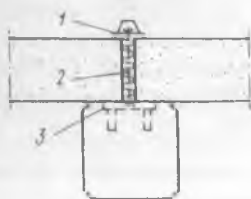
Соединение горизонтального стенового элемента с железобетонной колонной
